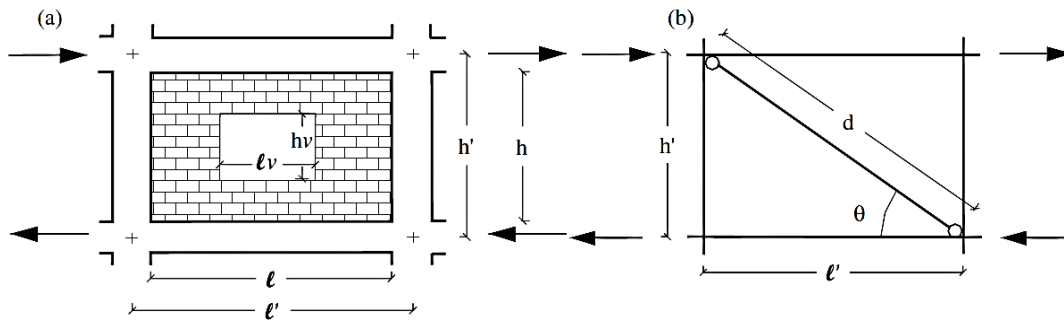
Nomenclatura empleada para el modelo, a) muro de mampostería no estructural con abertura, b) Macro-modelo (Asteris, Cavaleri, Di Trapani, & Sarhosis, 2015).
